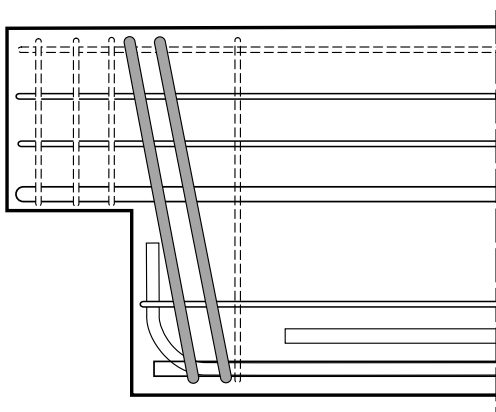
Bewehrungsführung mit leicht schrägen Rückhängebügeln
